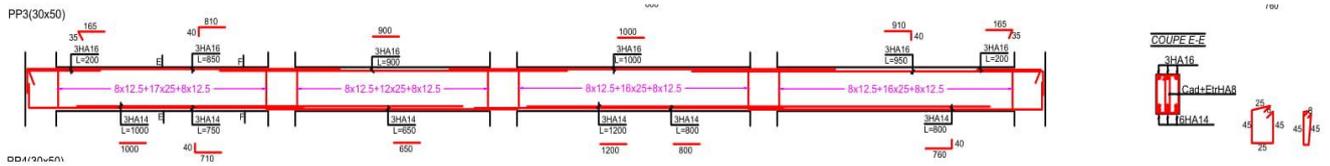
exemple de plan ferrailage d'une poutre 30x50
